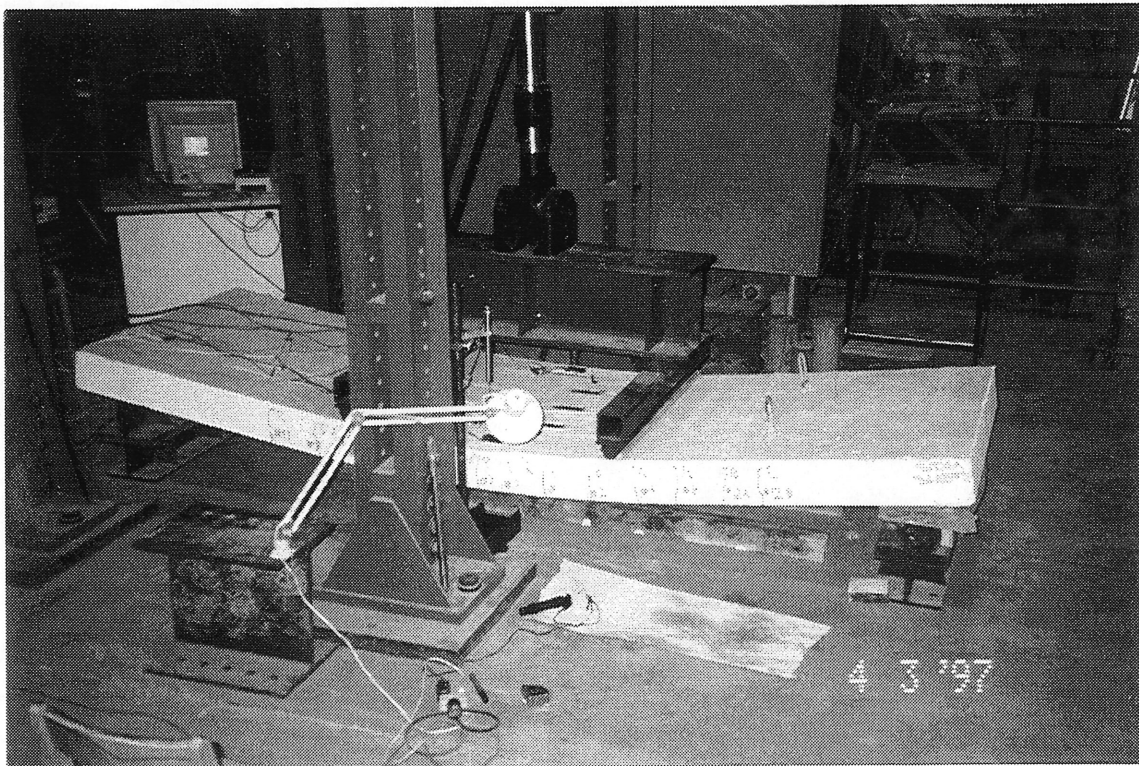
Grande déflexion de la dalle SC150U avant rupture
